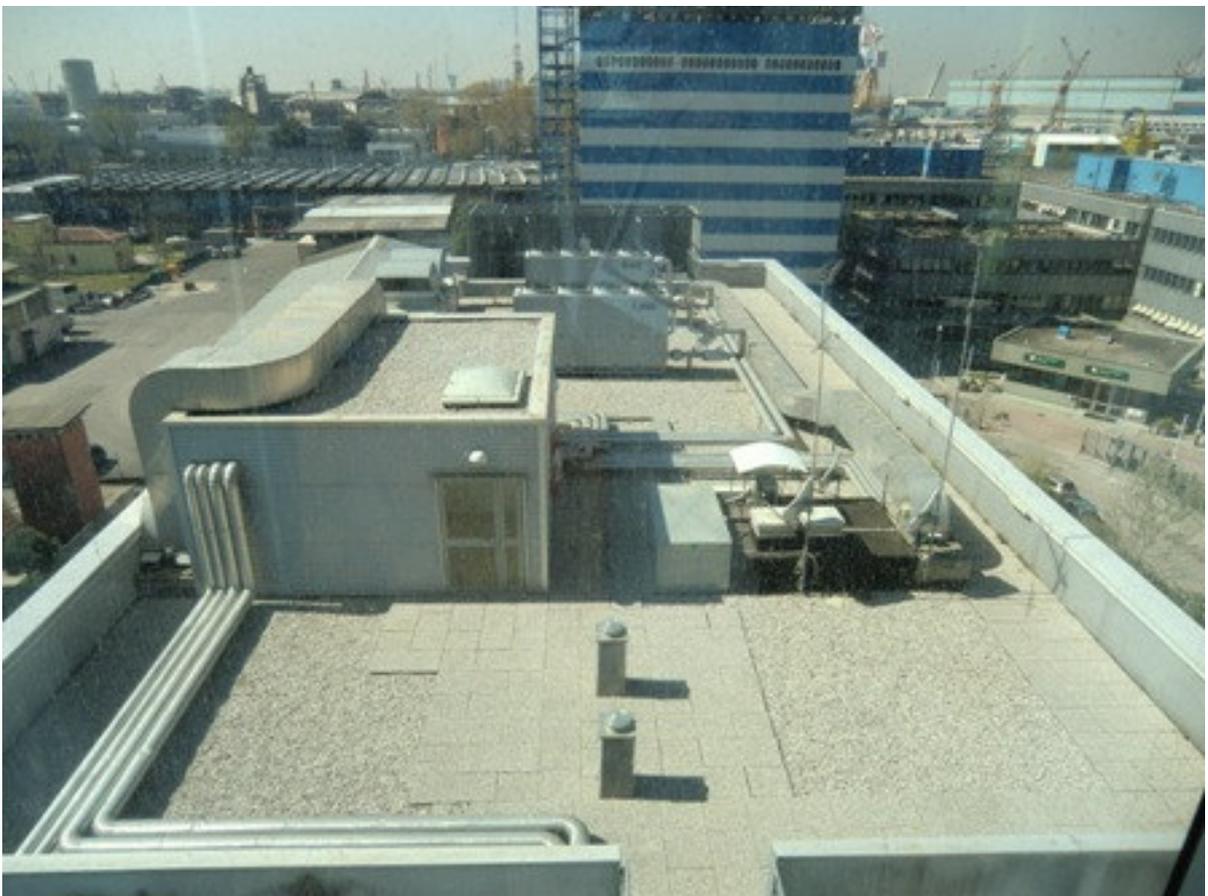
Lastrico solare mapp. 294 sub. 53 piano quinto (LOTTO 6)
